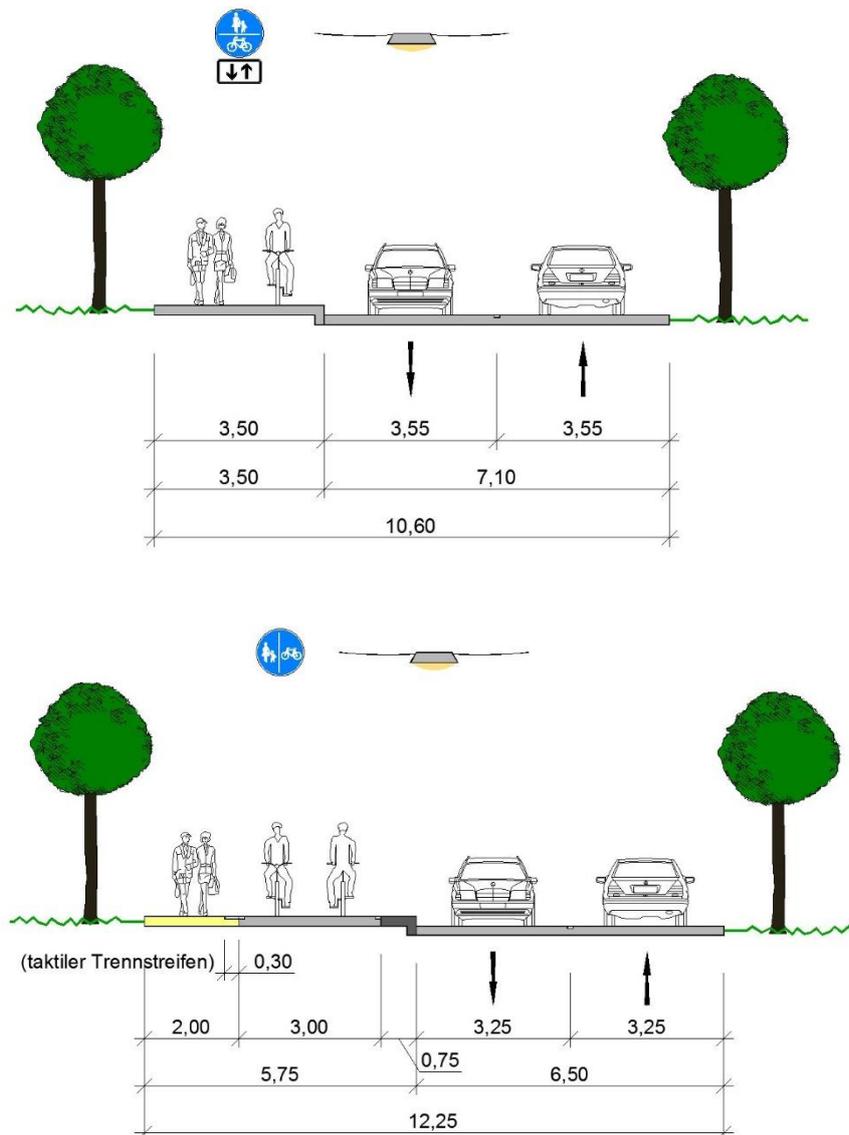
Bottroper Straße (Zeichenbahn – Hornstraße) – Bestand (oben) und Planung (unten)
